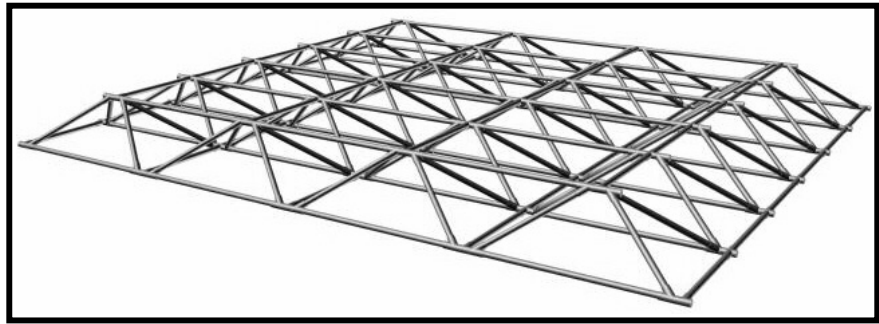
b: Ebenes Raumfachwerk mit modifizierten Elementen
